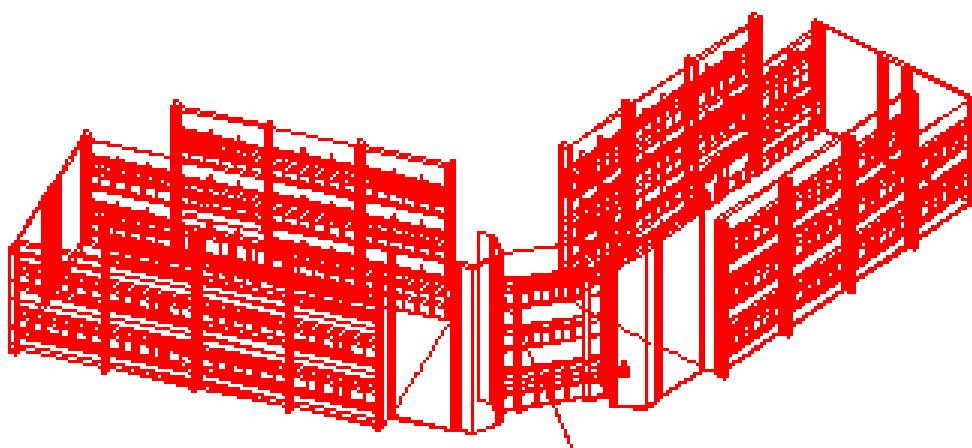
Modelo vetorial do prédio gerado no AutoCad a partir da planta baixa do projeto arquitetônico.
